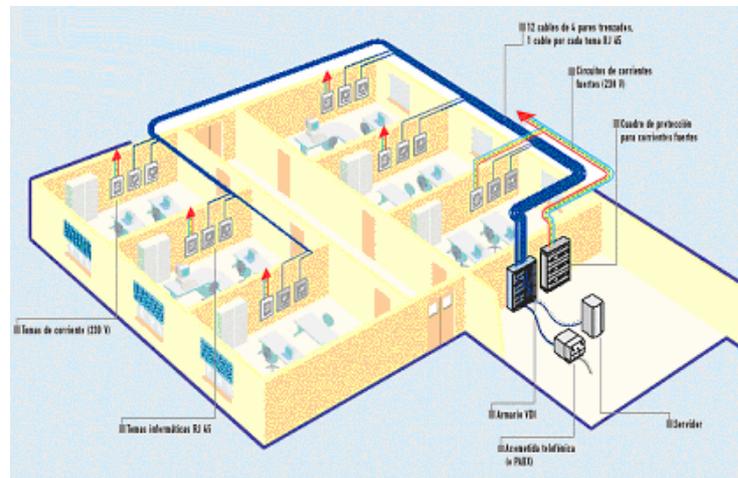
CABLEADO HORIZONTAL [18]
